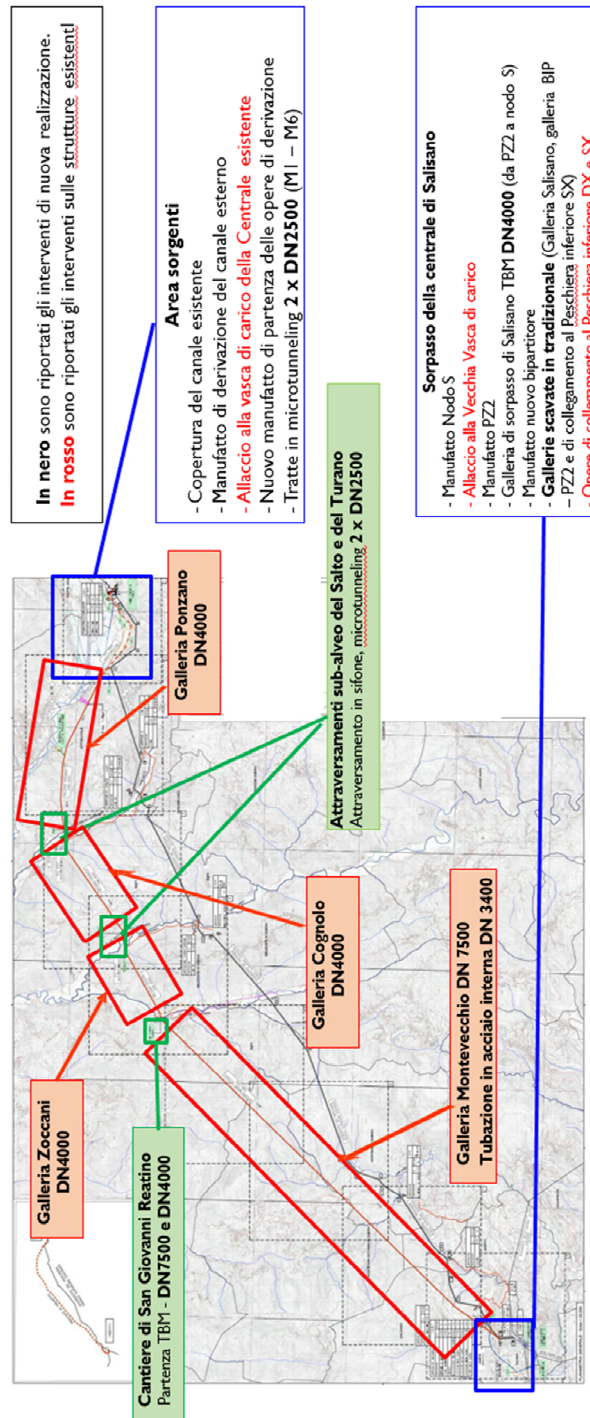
Nuovo Tronco Superiore dell’Acquedotto del Peschiera, Planimetria generale delle opere in progetto.
